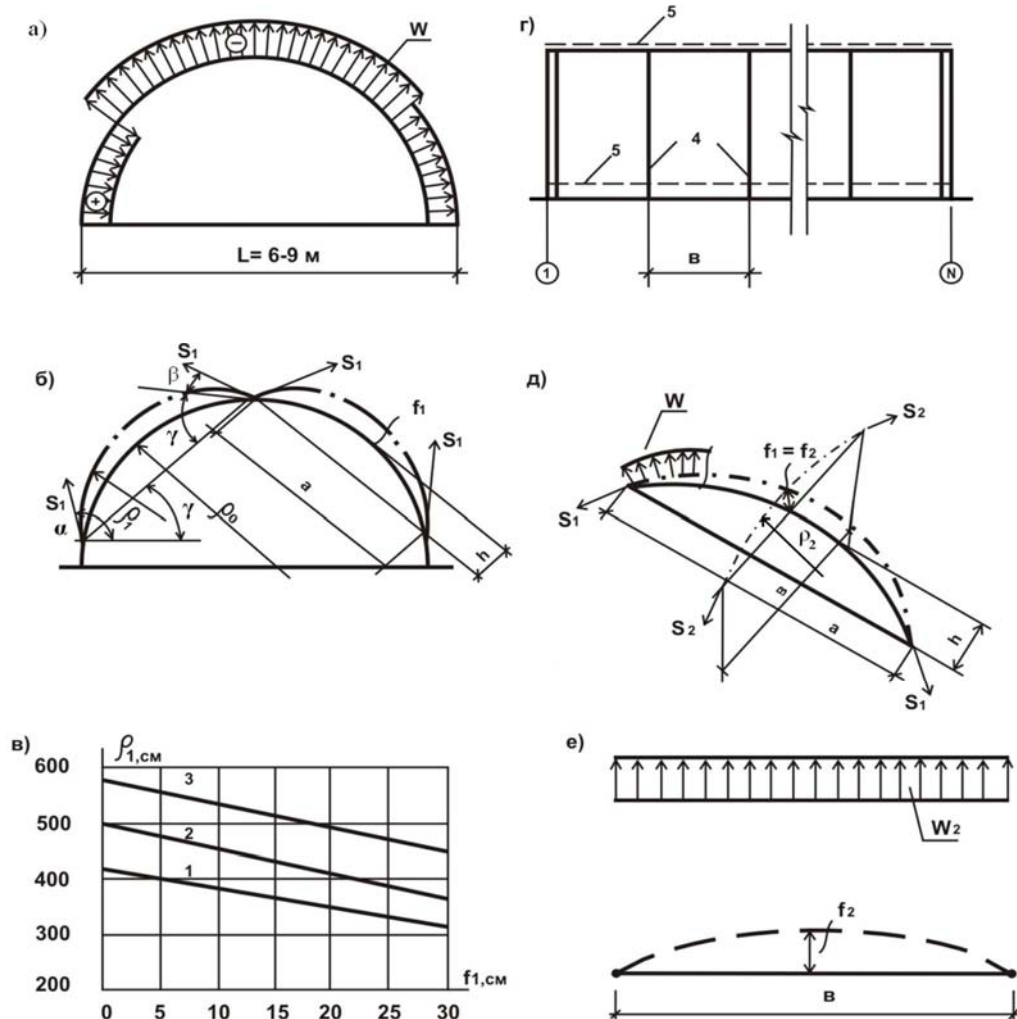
К статическому расчету мягкой кровли сооружения: а – схема ветровой нагрузки на сооружение; б – схема сооружения с деформированной кровлей; в – графики изменения радиуса кривизны кровли; г – схема расположения ветровых канатов по длине сооружения; д – схема совместности деформаций в рассчитываемых нитях; е – расчетная схема нити между ветровыми канатами; 1 – пролет сооружения 6 м; 2 – пролет 7,5 м; 3 – пролет 9 м; 4 – ветровой канат; 5 – элементы крепления кровли в коньке и цоколе сооружения
